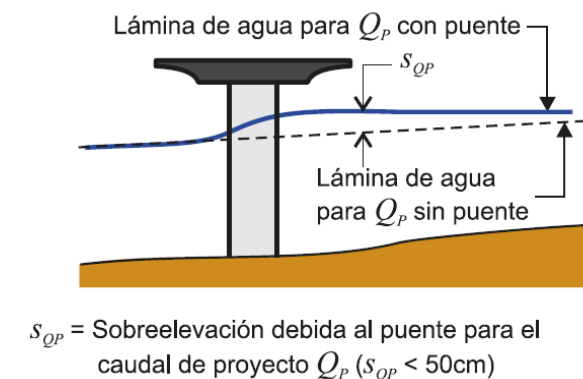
Figura 4.2 SOBREELEVACIÓN DEL NIVEL DE LA CORRIENTE EN PUENTES. Fuente: Norma 5.2-IC de la Instrucción de Carreteras. Drenaje superficial
